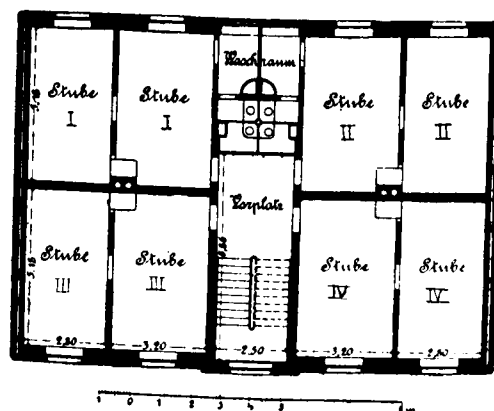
Grundriss eines Arbeiterwohnhauses für 16 Familien.
